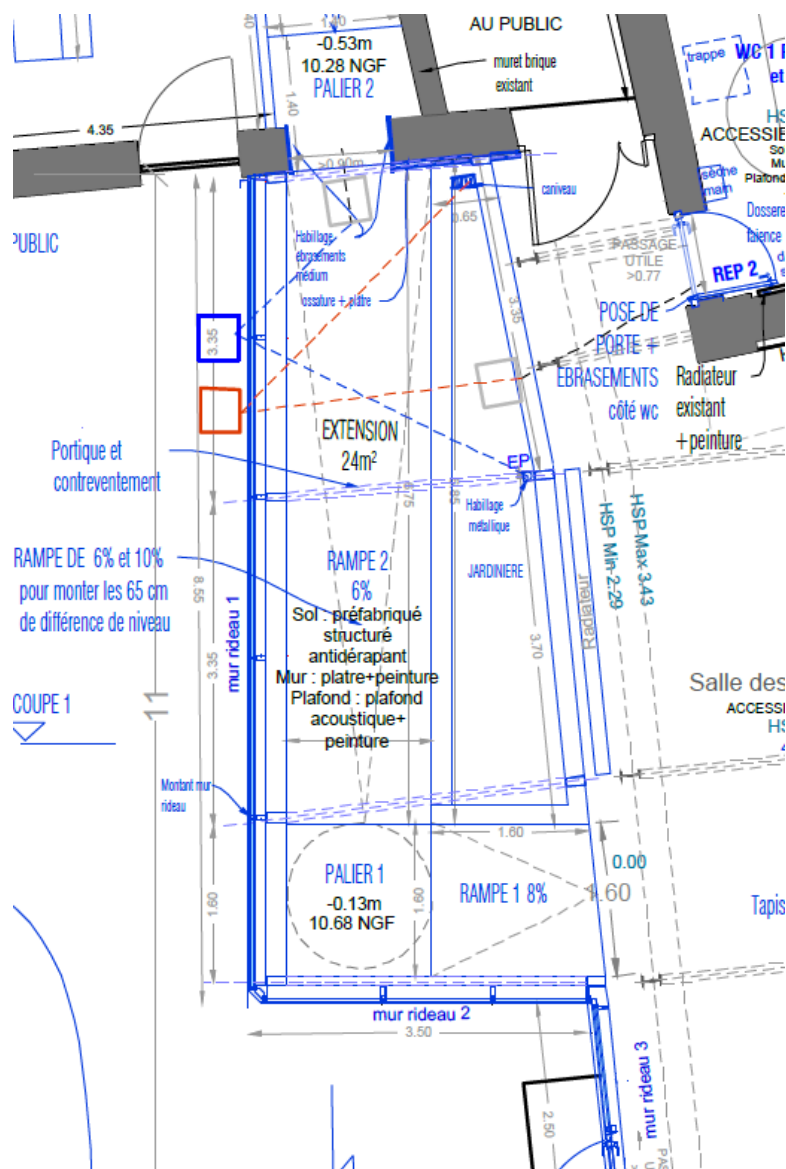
Plan de la rampe (Source : Ar.t architecte)
